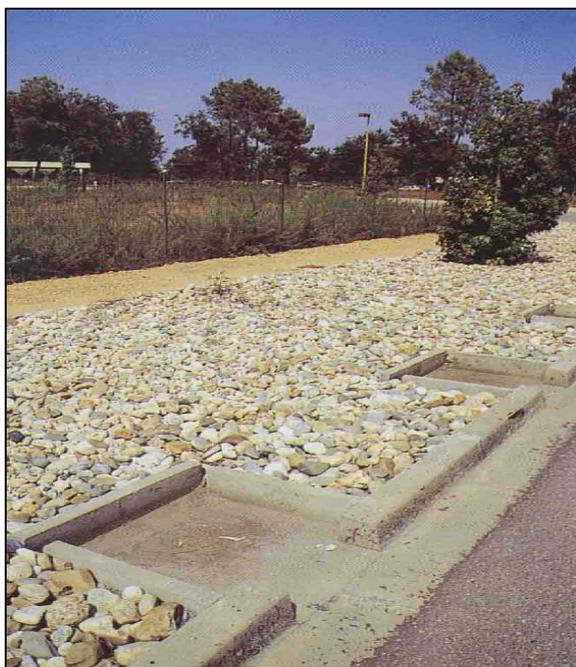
Exemples de tranchée d'infiltration le long d'un voirie
